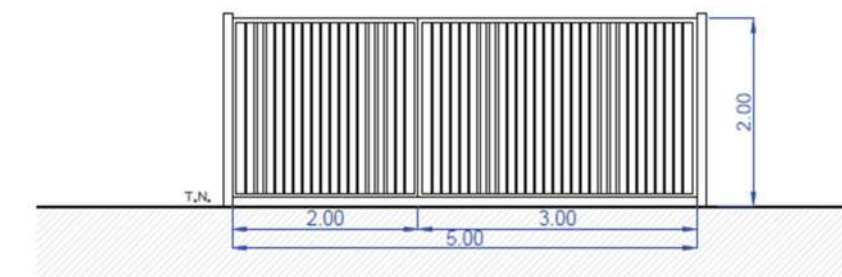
Schéma de principe du portail (source : EDF Renouvelables France)
